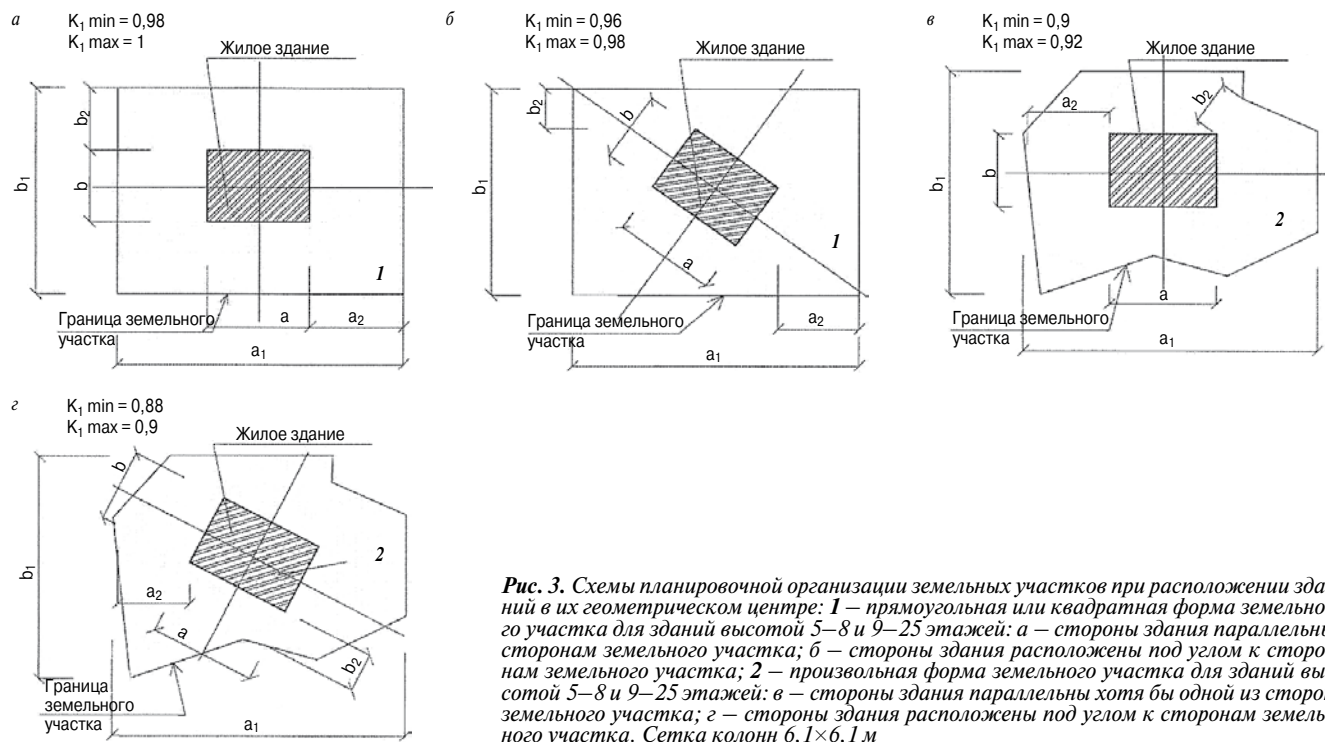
Схемы планировочной организации земельных участков при расположении зданий в их геометрическом центре: 1 – прямоугольная или квадратная форма земельного участка для зданий высотой 5–8 и 9–25 этажей; а – стороны здания параллельны сторонам земельного участка; 2 – произвольная форма земельного участка для зданий высотой 5–8 и 9–25 этажей; в – стороны здания параллельны хотя бы одной из сторон земельного участка; г – стороны здания расположены под углом к сторонам земельного участка. Сетка колонн 6,1×6,1 м
